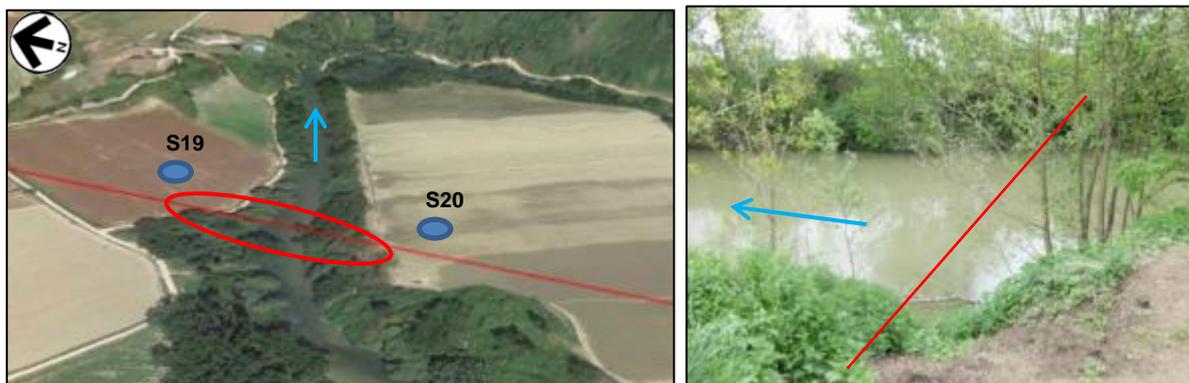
S: Vista dell'attraversamento Tevere 1 in trenchless
